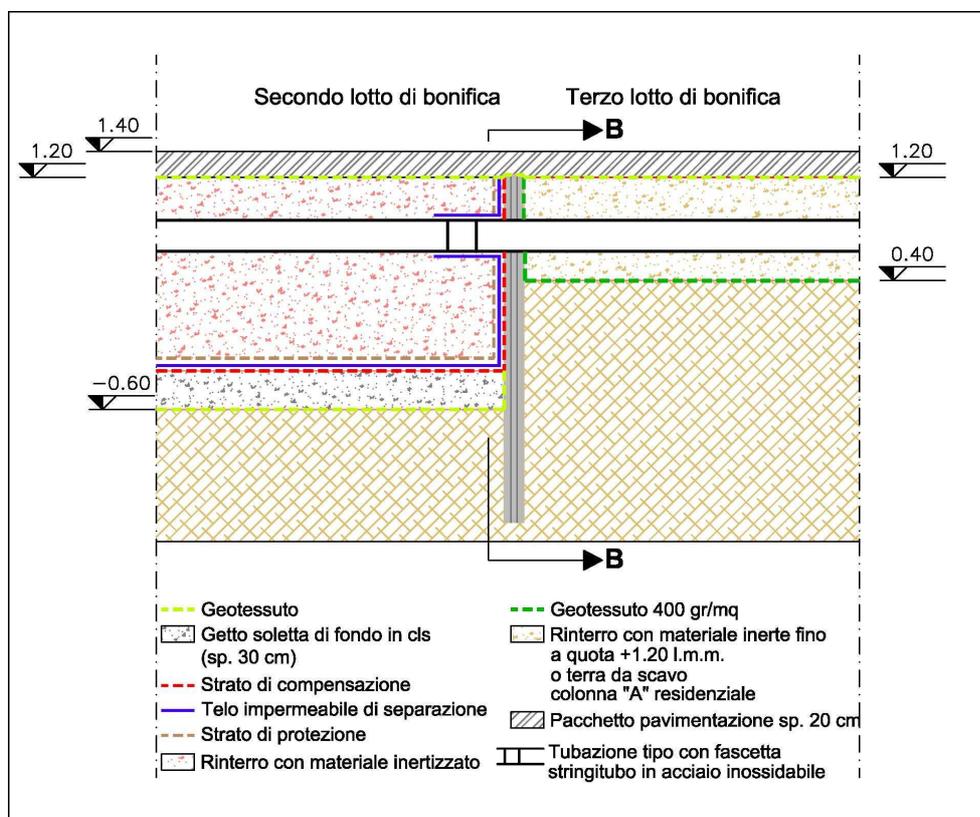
Sezione tipo intersezione tubazione con palancole
